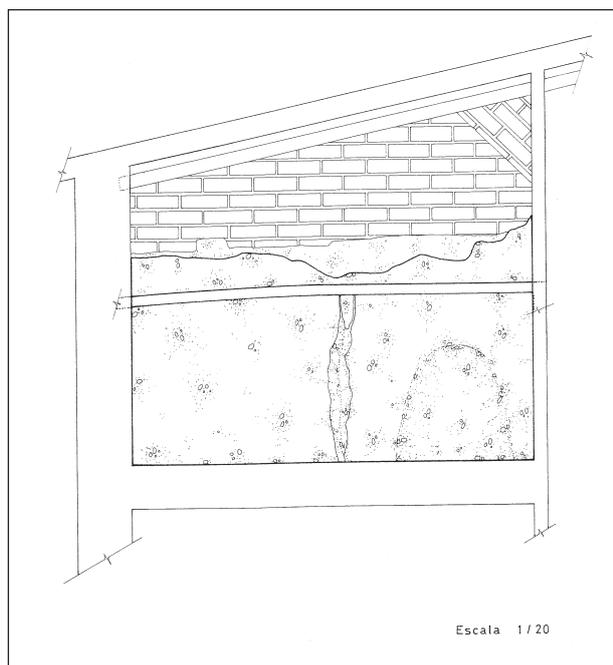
Torre n° 1. Alzado Norte. 2ª Planta (Casa de los Rosendos).
